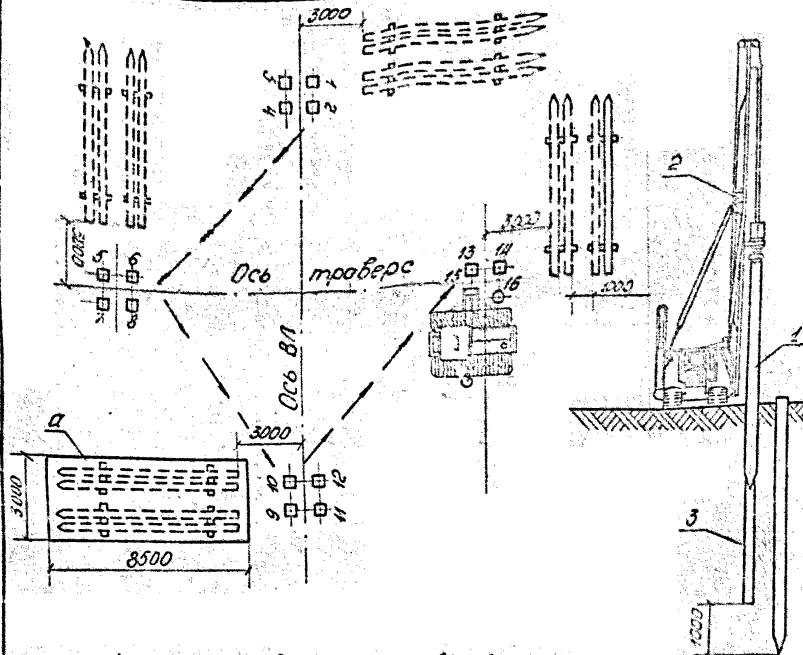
Схема движения сваебойного агрегата СП-49 при погружении свай.
